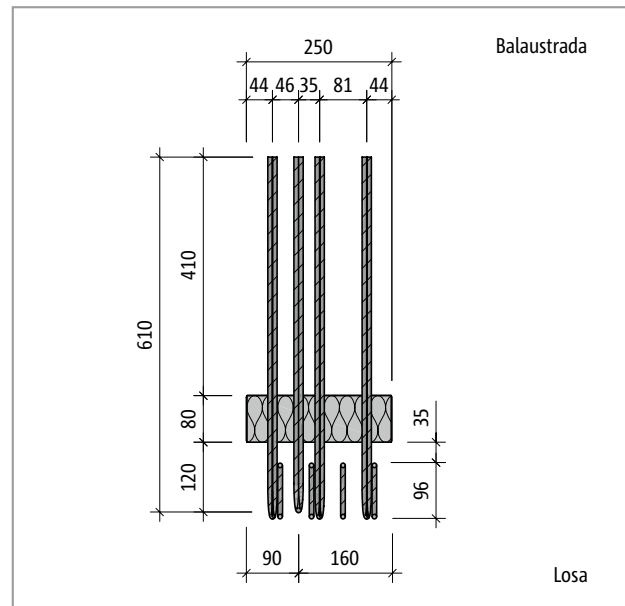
Schöck Isokorb® T tipo A-MM2-X80: Vista del producto
